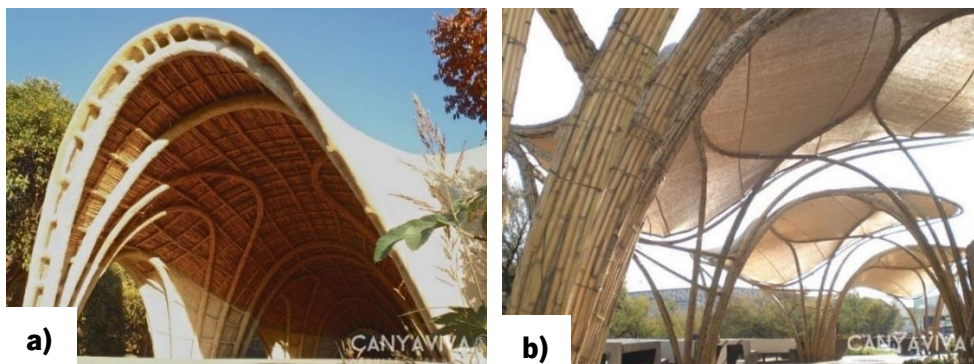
Casa Laila, construção permanente (a); Expo Zaragoza 2008, construção efêmera (b) (Canyaviva, n.d.).
